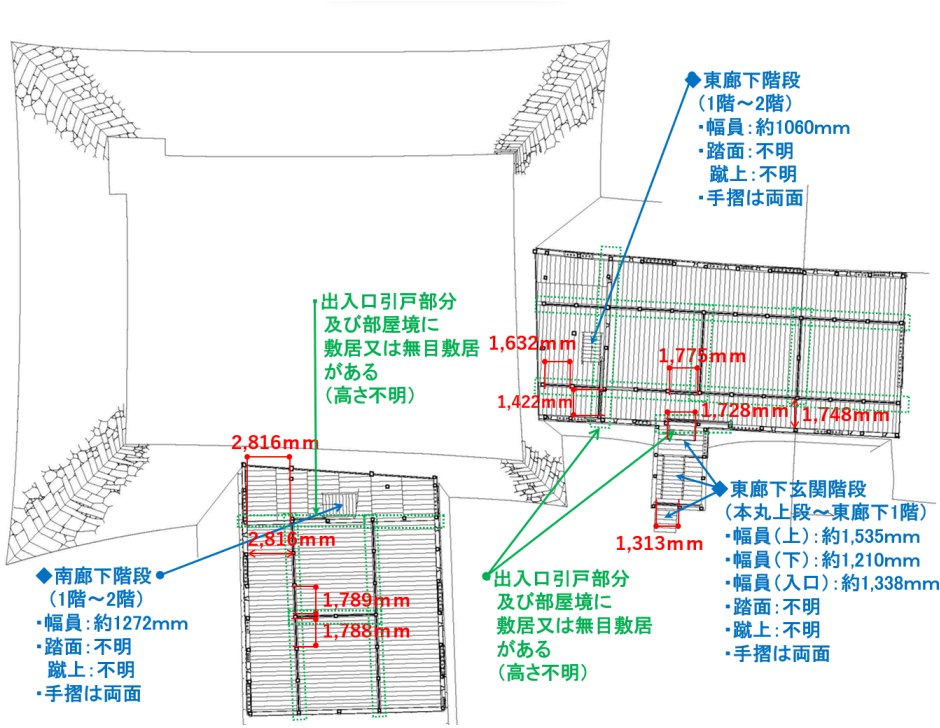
東廊下・南廊下 1 階平面図（復元原案）
